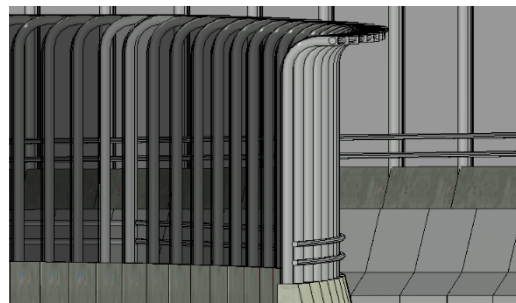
Tampilan Placing Permodelan Upper Structure Sesuai dengan Elevasi
